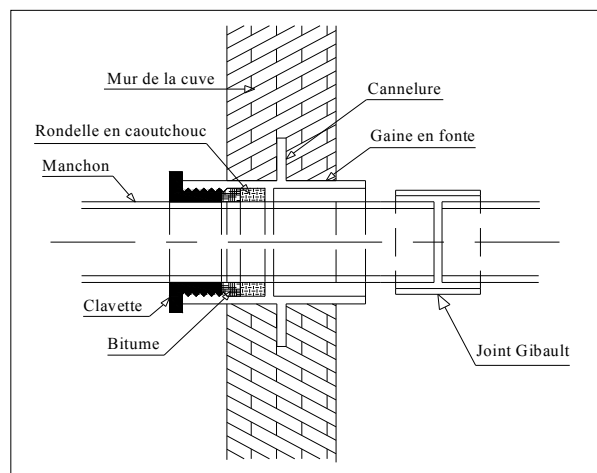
b: Traversée des conduites (Gaine en fonte)
